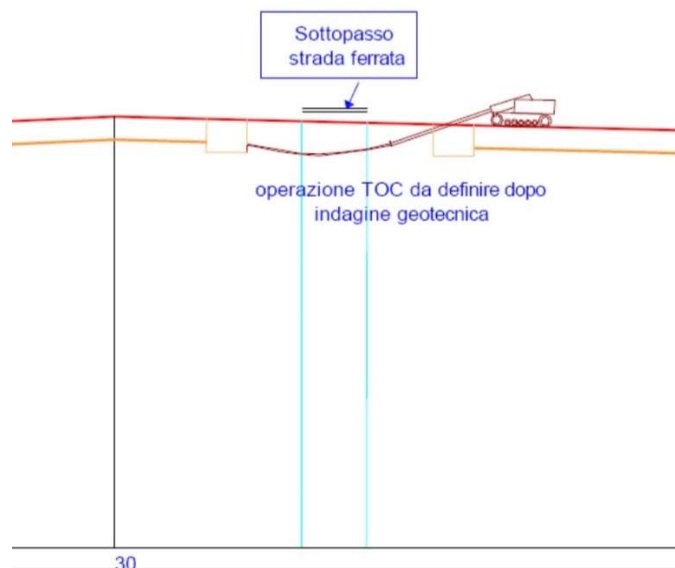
Sezione Cavidotto di connessione 36 KV con la stazione RTN 380/150/36 KV con operazione TOC
